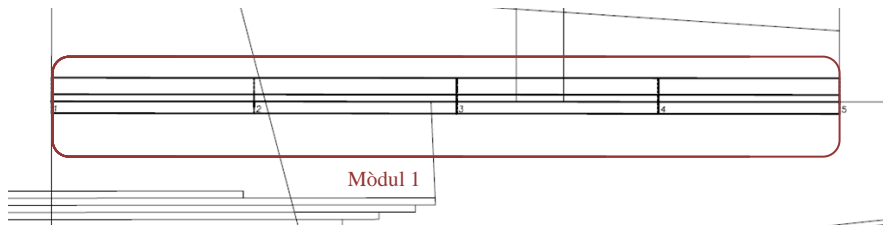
Plànol núm.18.1 full 3 Mur 2 planta.
